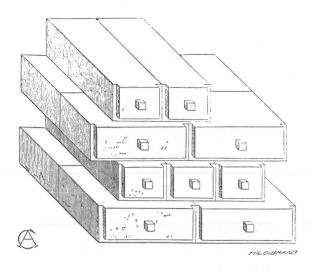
Sillería de los muros de las fortificaciones del Pireo
